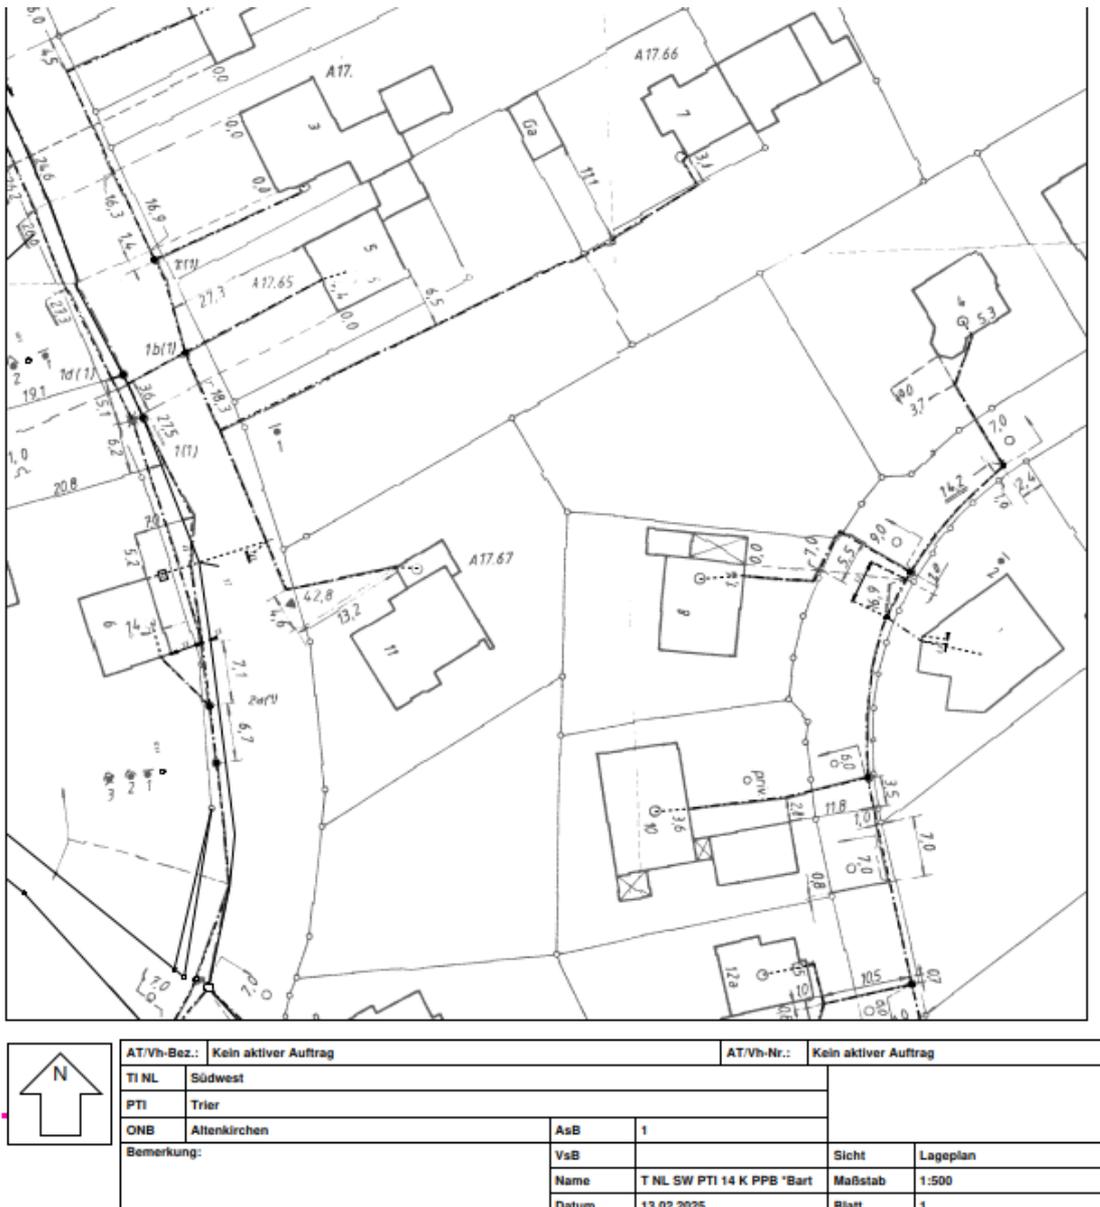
Plan zur Lage von Leitungen der Telekom Deutschland GmbH
